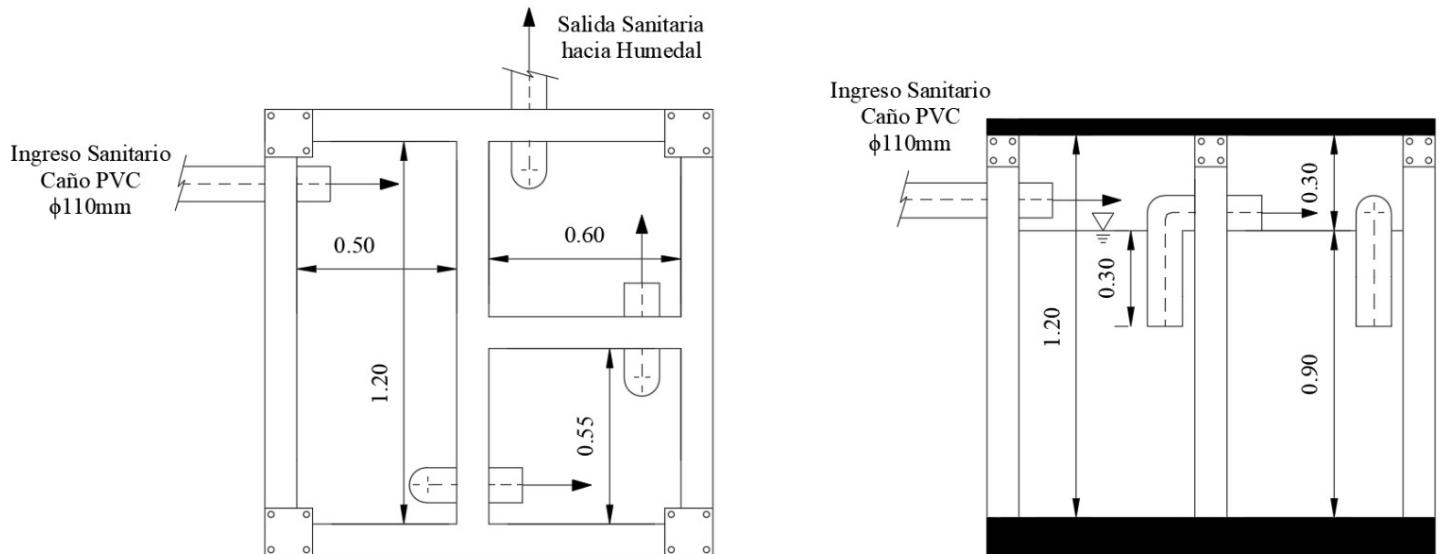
Vista en planta y corte de cámara séptica triple familiar.
